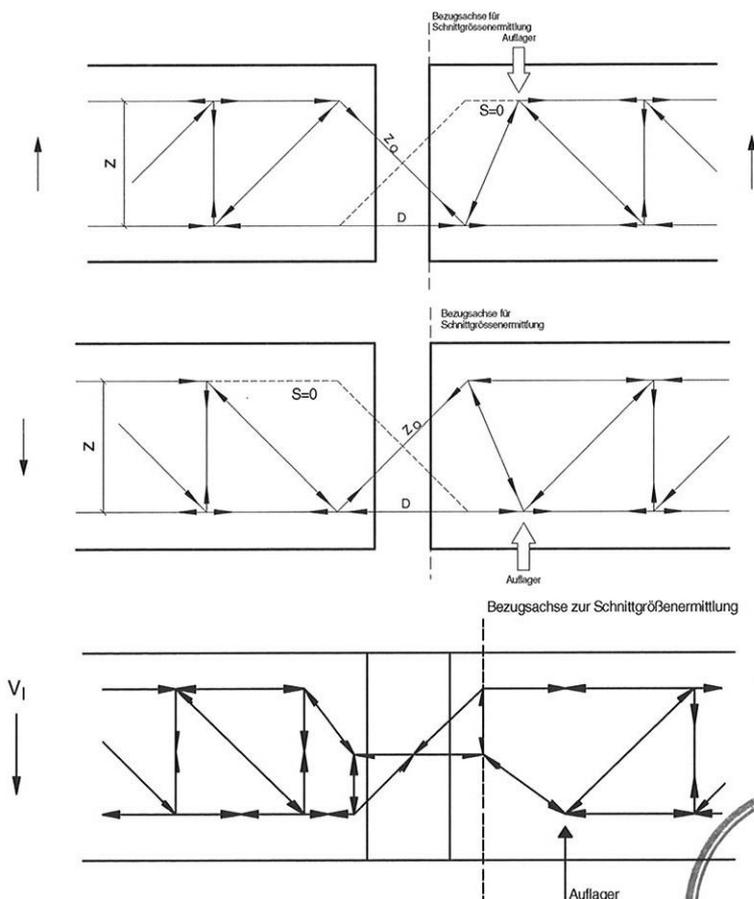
Egcobox Plattenelement Fachwerkmodell Typ PV +/-; PV-D +/-; PV-DD +/-
